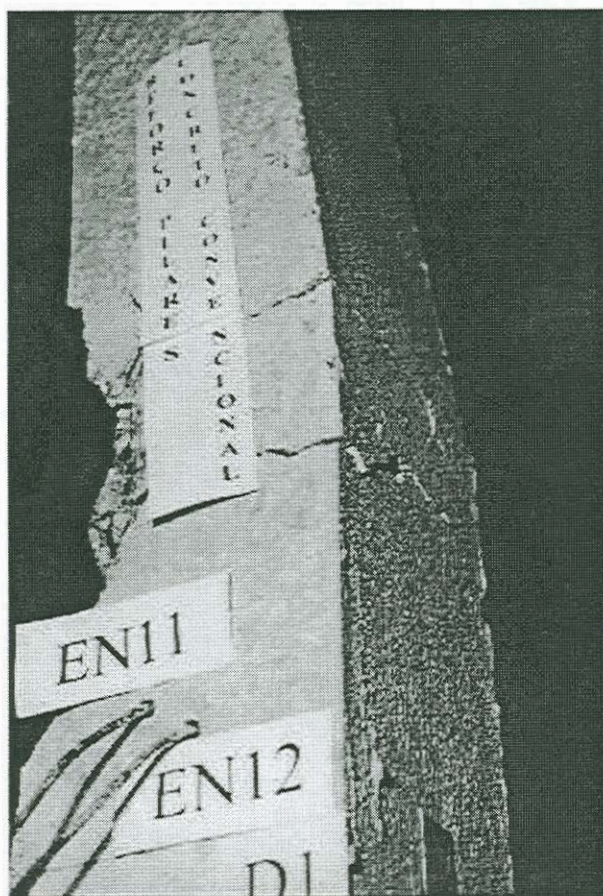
Ruptura do pilar reforçado com concreto armado nas 4 faces.
